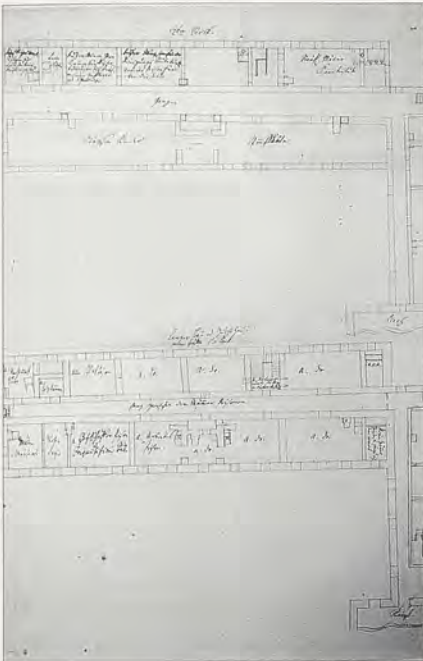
Langer Bau. Grundriß des 1. und 2. Stocks im südlichen Abschnitt.
